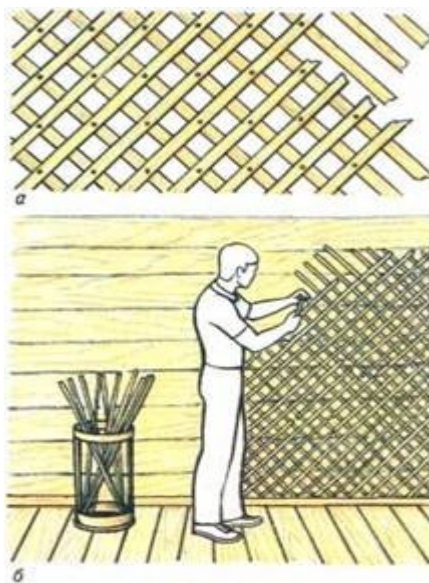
Подготовка деревянных поверхностей: *а* - расположение драниц; *б* - набивка драниц.
